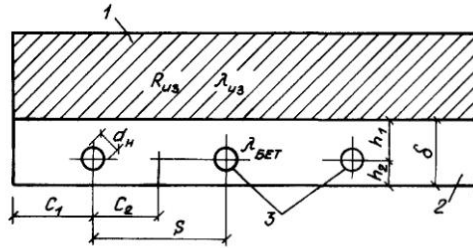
Расчетная схема размещения нагревательных элементов в конструкции перекрытия (сплошная плита)
